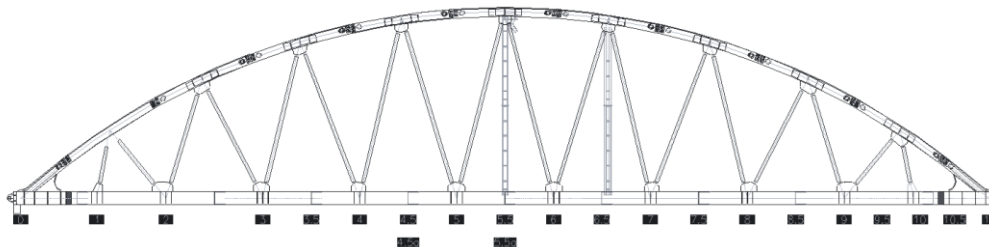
Ubicación de apoyo sobre viga tirante para referencia
